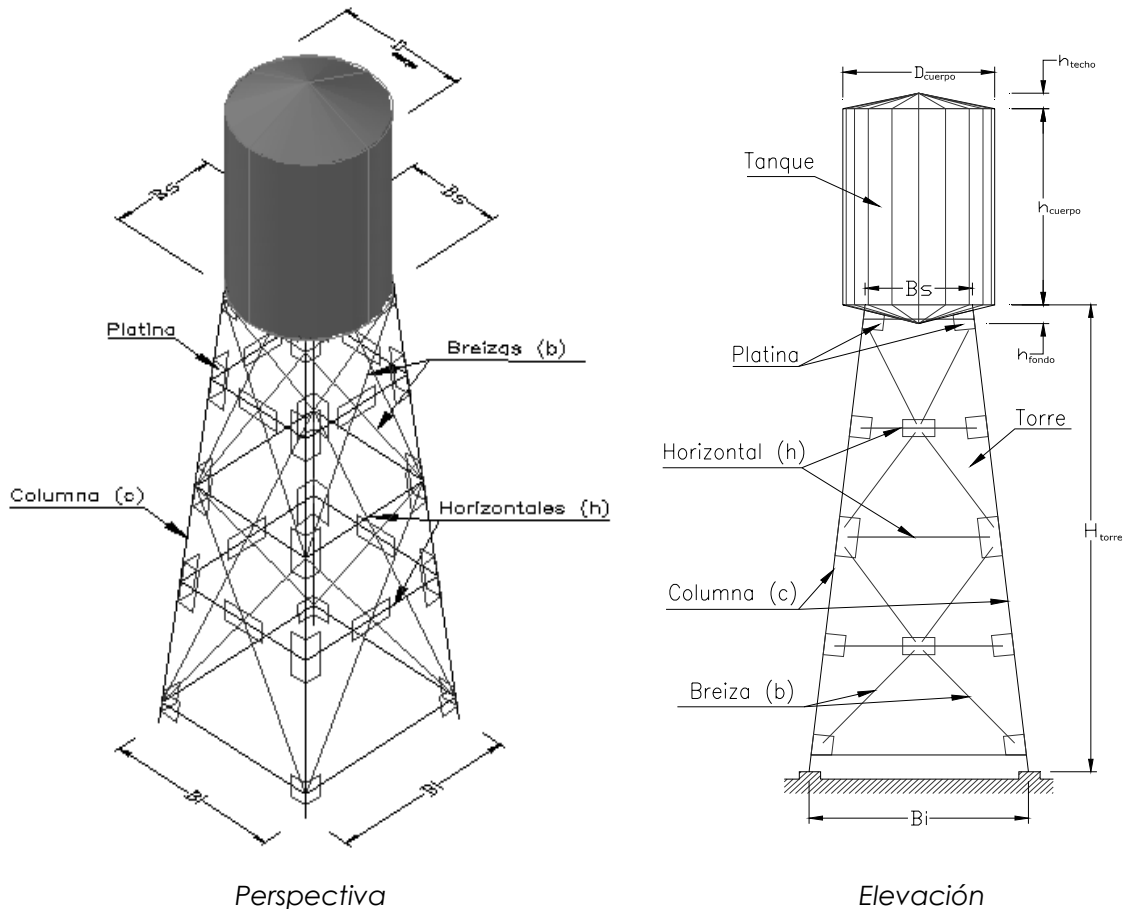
Perspectiva y elevación, modelo esquemático de tanque metálico elevado
